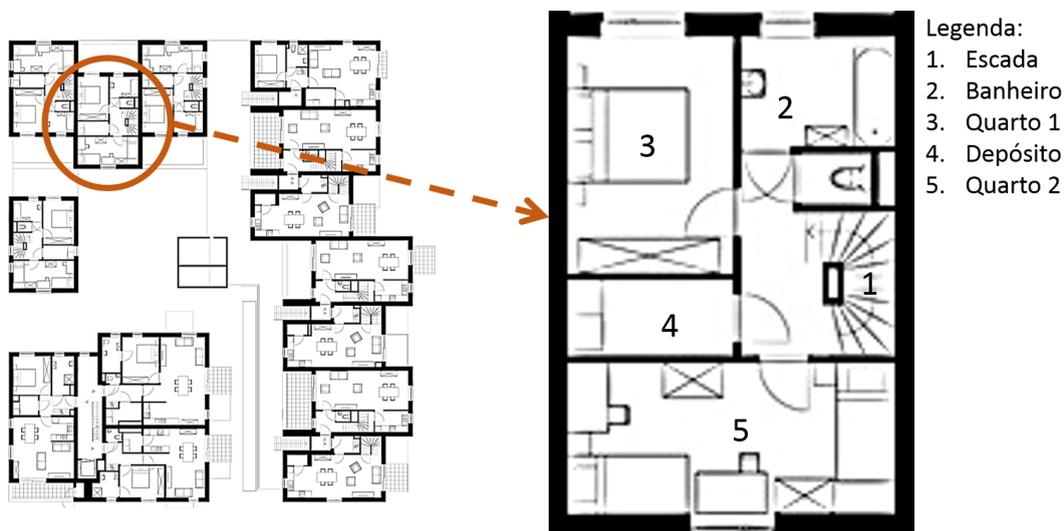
Planta Baixa Pavimento Térreo, Tipologia Comum B.
